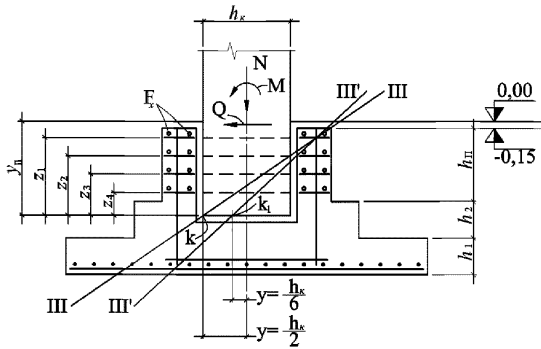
Расчетная схема стаканной части при заглублении стакана в плитную часть фундамента
